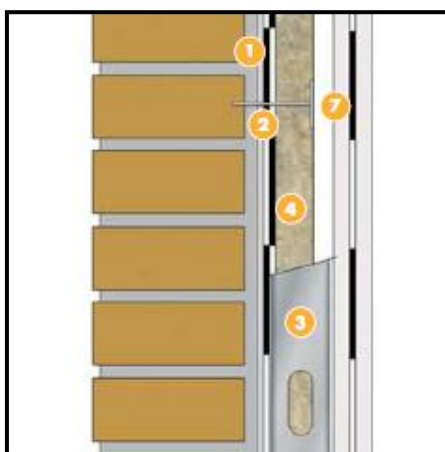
Esquema del aislamiento en una pared. (1) Guarnecido de yeso. (2) Primera capa de aislamiento SONODAN PLUS. (3) Perfilería de acero: canal y montante. (4) Segunda capa de aislamiento SONODAN PLUS. (7) Fijaciones PVC 40.
